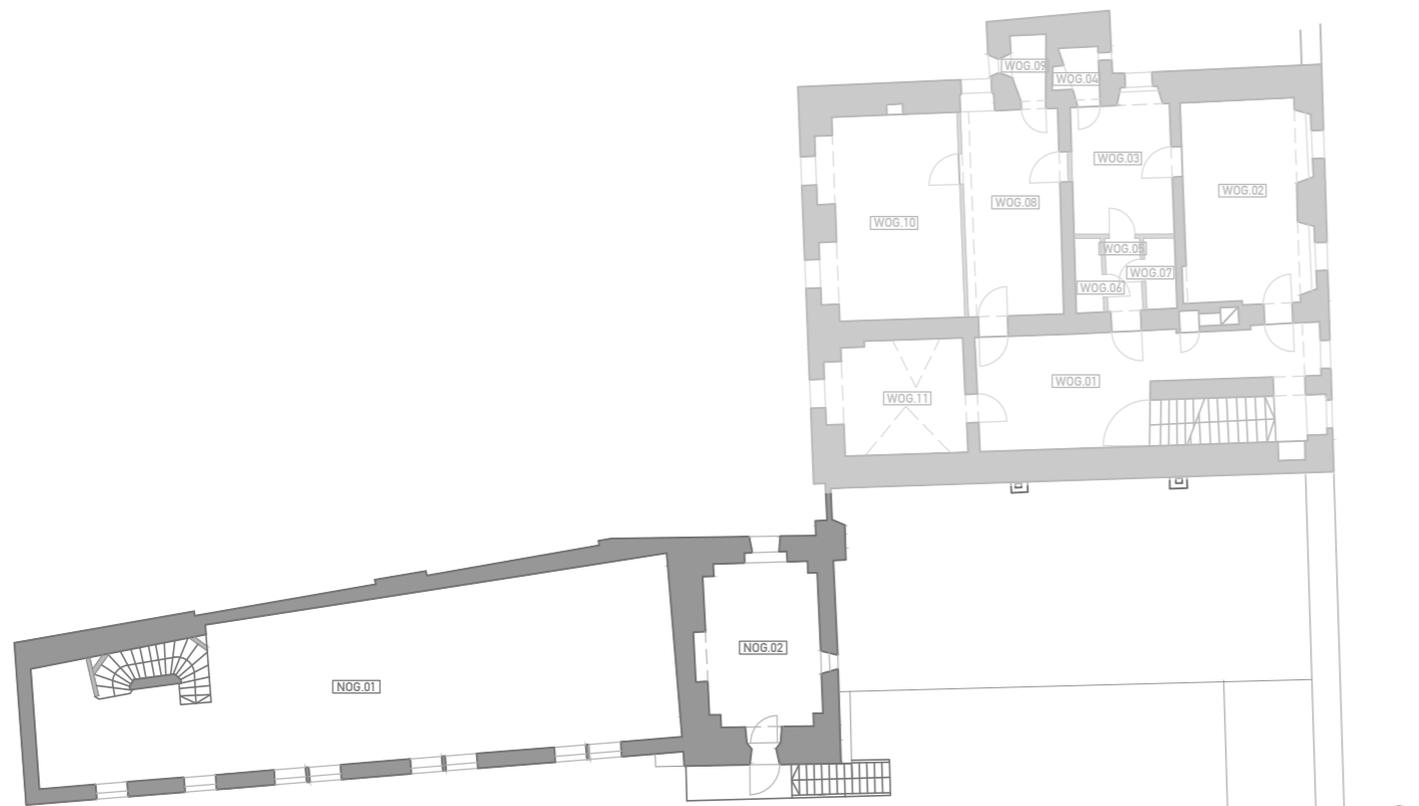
Nebengebäude Bestand Grundriss Obergeschoß
